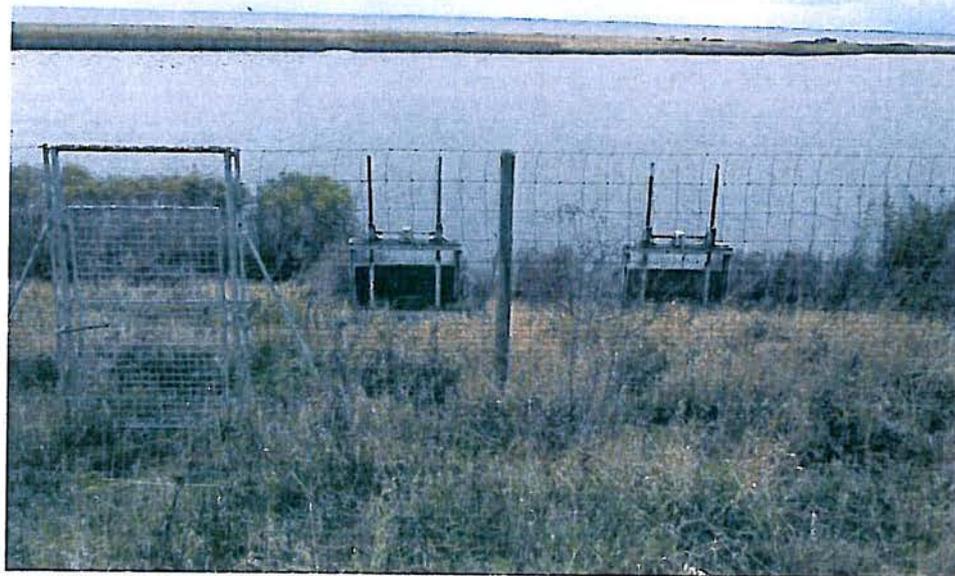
Schöpfwerksauslauf mit Hubschützenanlagen
